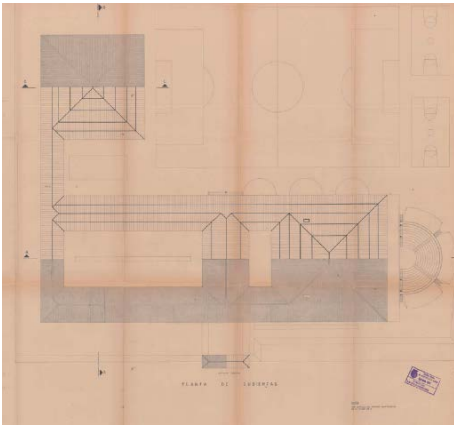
Planta de Cubiertas. Planos originales. Fondo Fundación Aljarafe.
